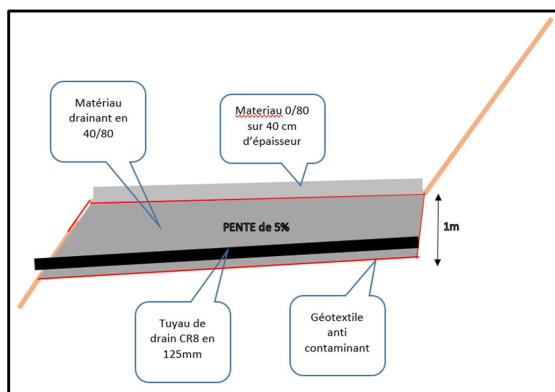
schéma de la tranchée drainante en traversée de chaussée
